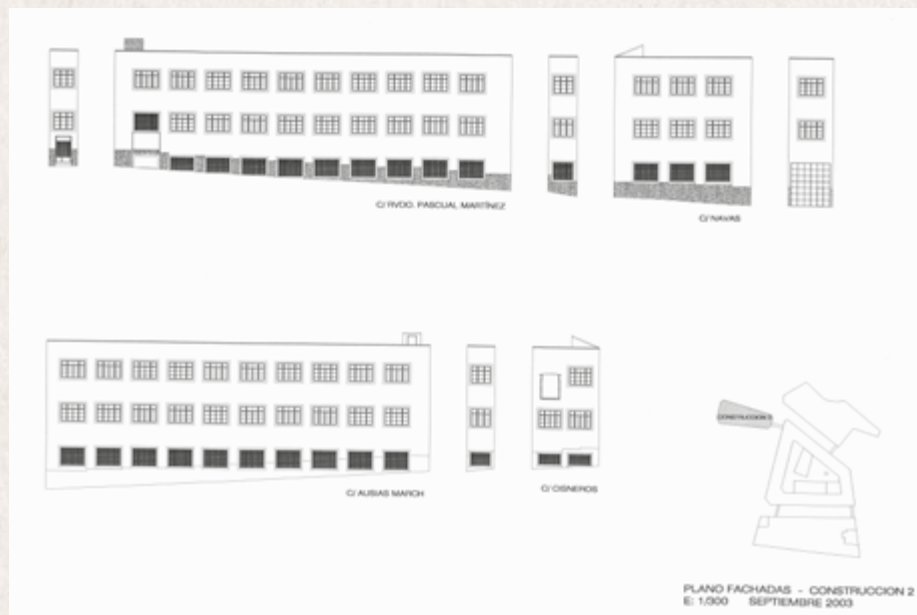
Alzado fachadas construcción 2 del complejo de Alfombras Imperial. Plano de Irene Moreno.
